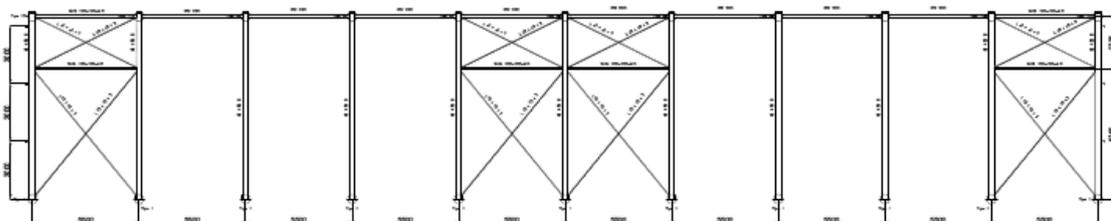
Estructura Lateral y Viga Perimetral
